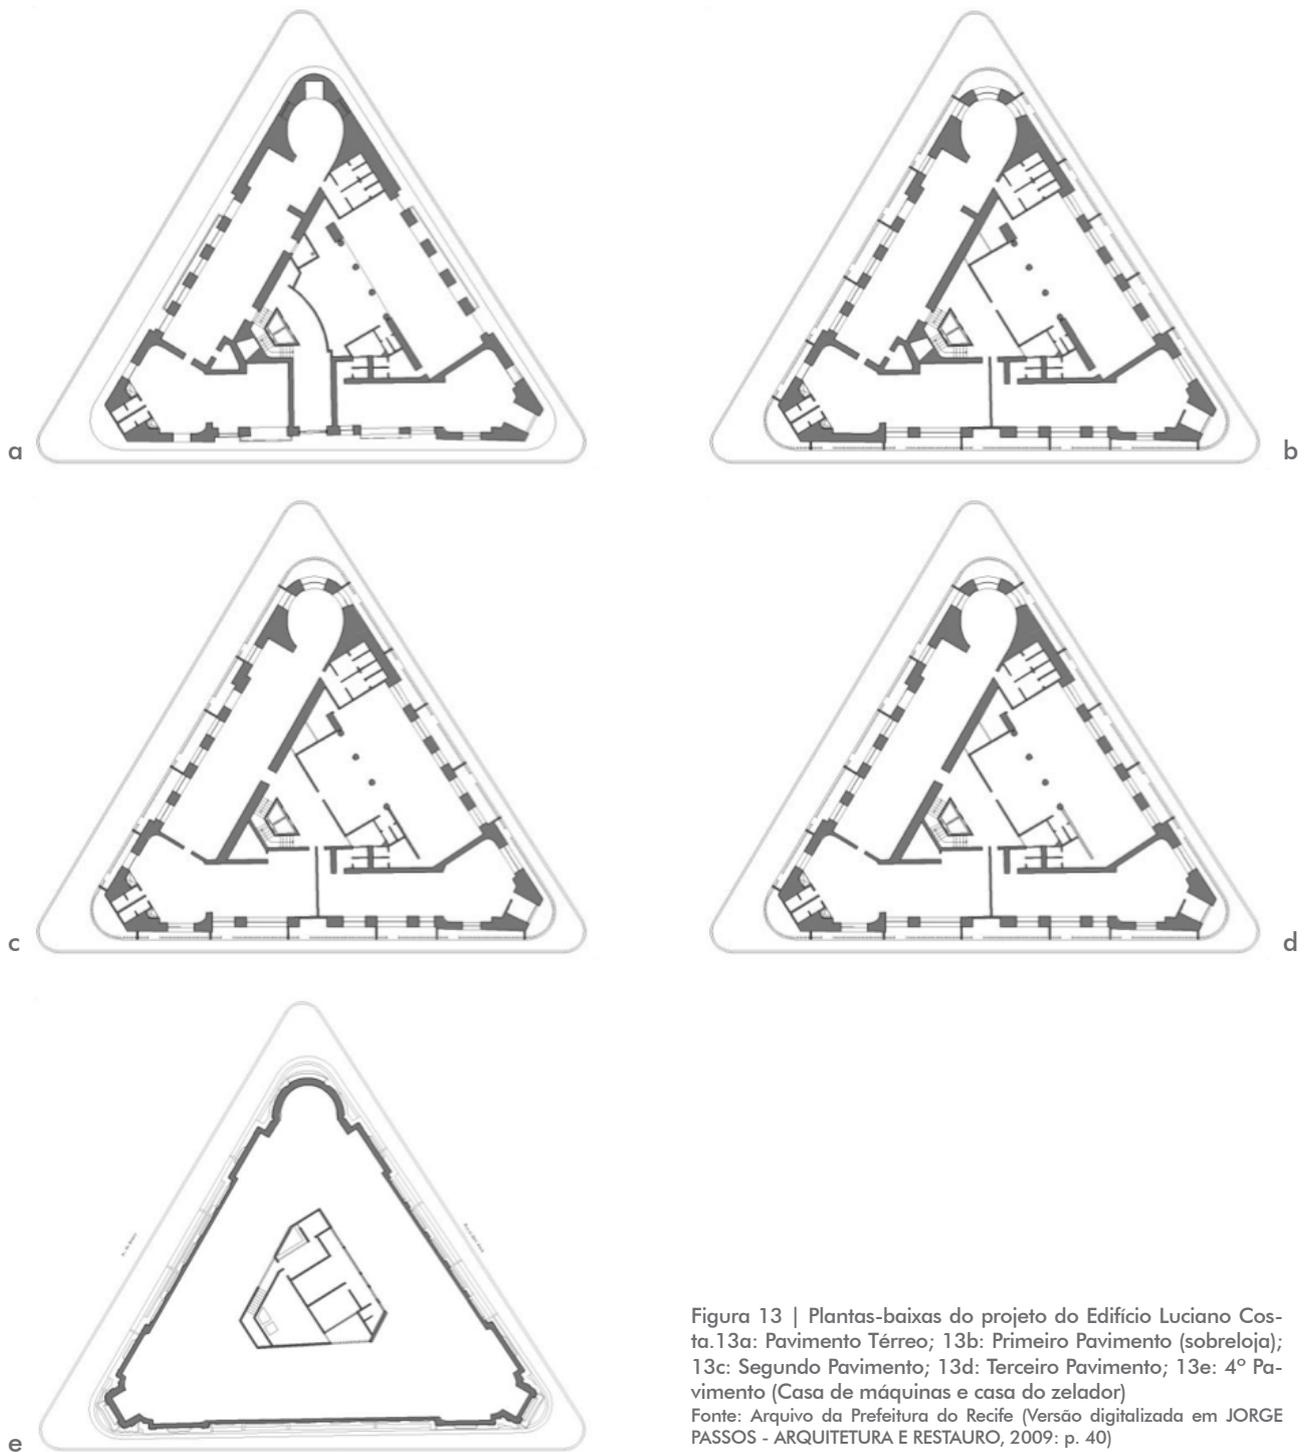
| Plantas-baixas do projeto do Edifício Luciano Costa. 13a: Pavimento Térreo; 13b: Primeiro Pavimento (sobrelója); 13c: Segundo Pavimento; 13d: Terceiro Pavimento; 13e: 4º Pavimento (Casa de máquinas e casa do zelador)
